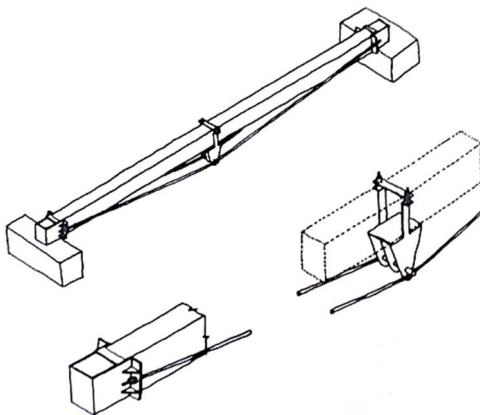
Refuerzo de viga mediante un tirante inferior.
